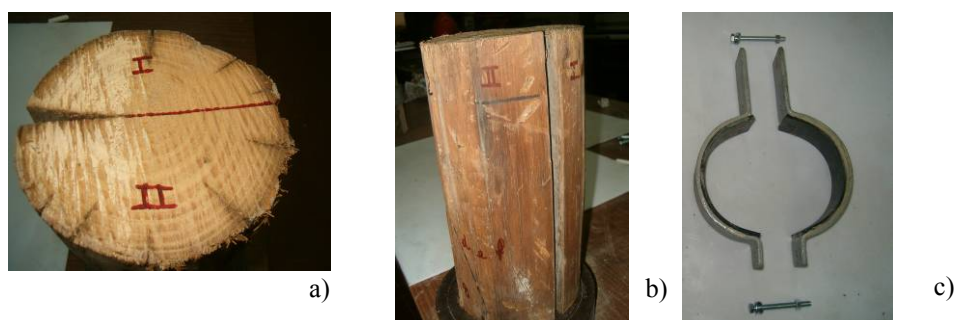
Sistema per trave a sezione circolare: a,b) Sezione e prospetto del tronco; c) Manicotto con gomma.
